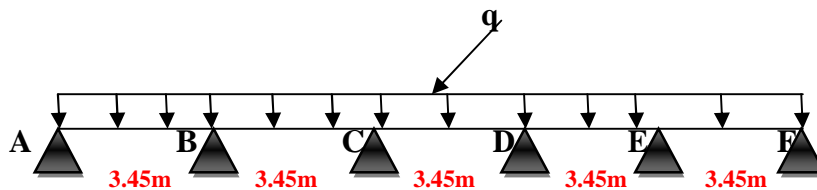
Schéma statique de la poutrelle T1 (les planchers courants)
